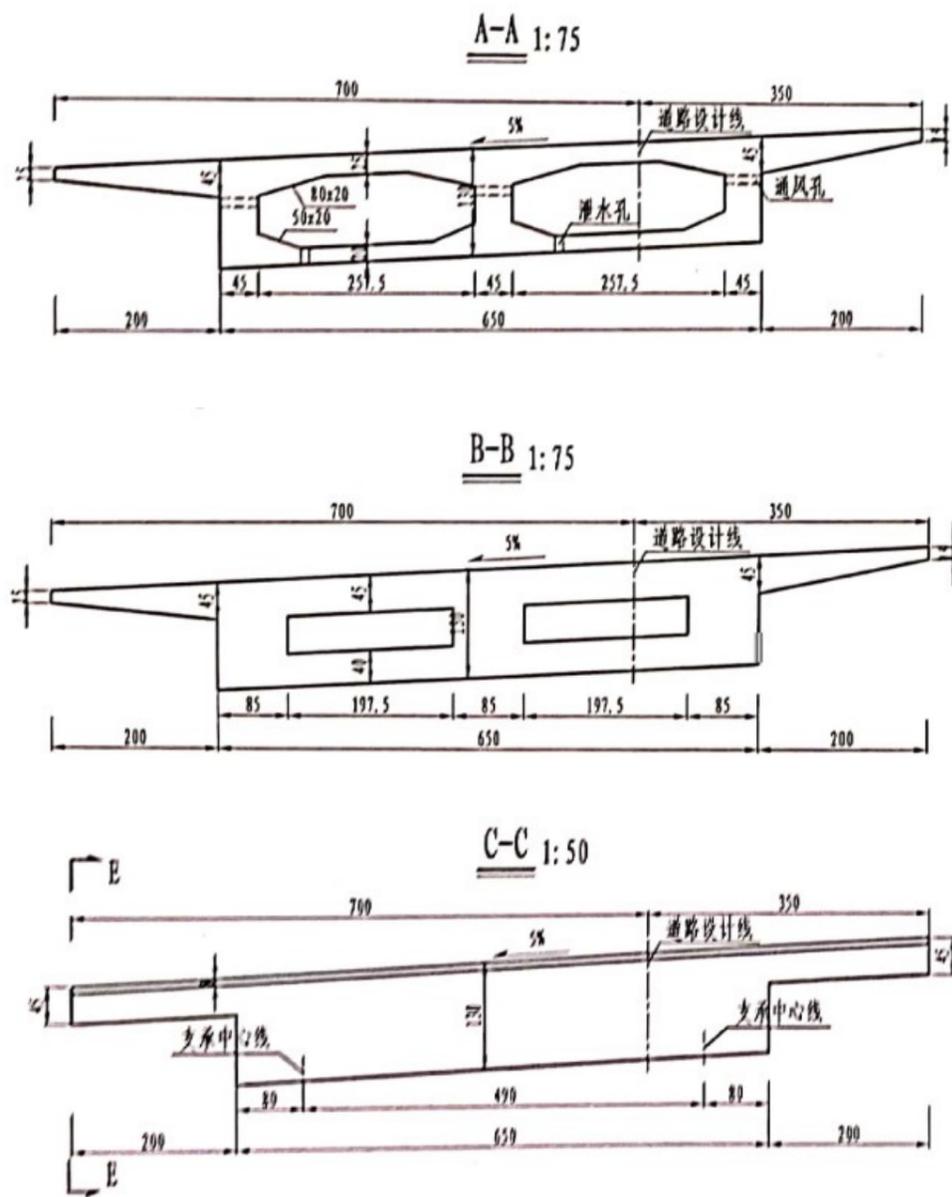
桥梁上部结构横断面布置图 (单位: cm)
